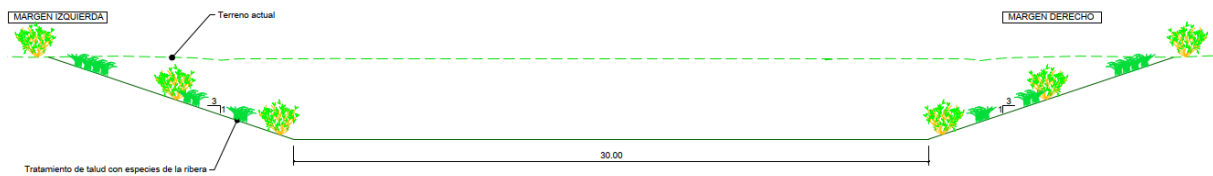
Sección tipo barranco Barxeta Fase II. Sección nueva.
